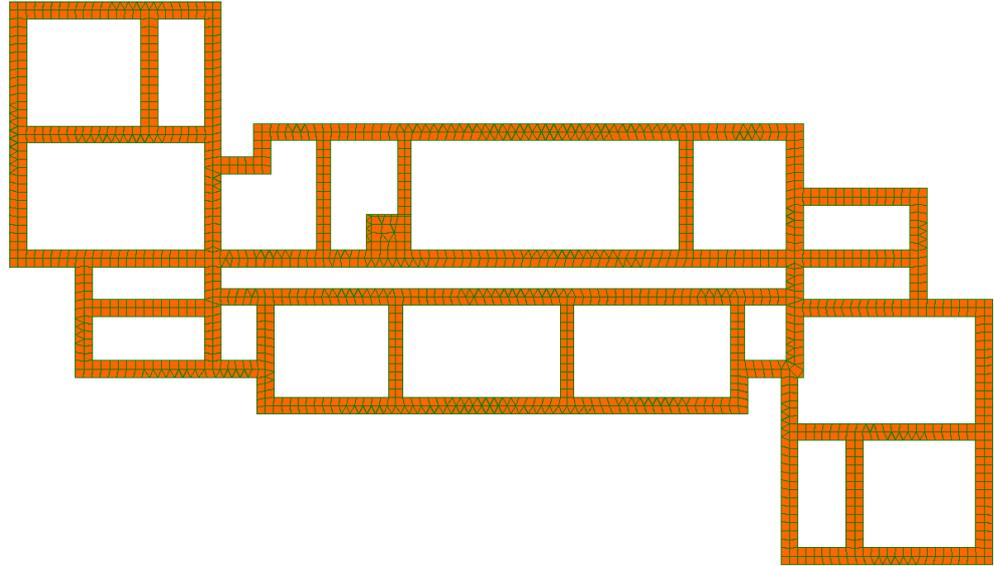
Расчетное нижнее армирование по оси (Y)
